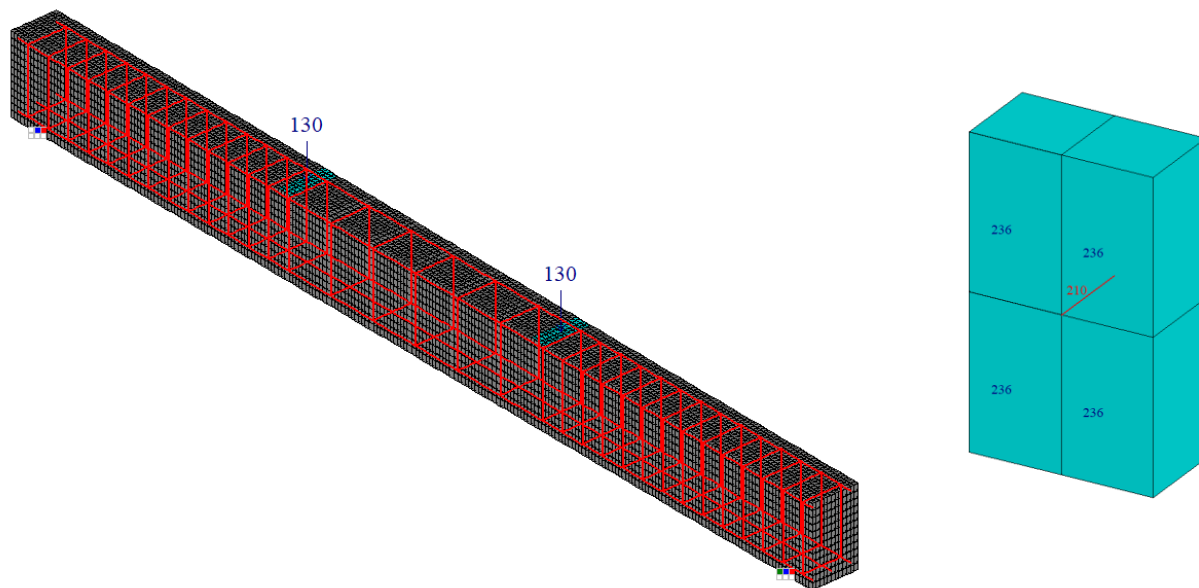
Объёмно–конечно элементарной модели натурной железобетонной балки
